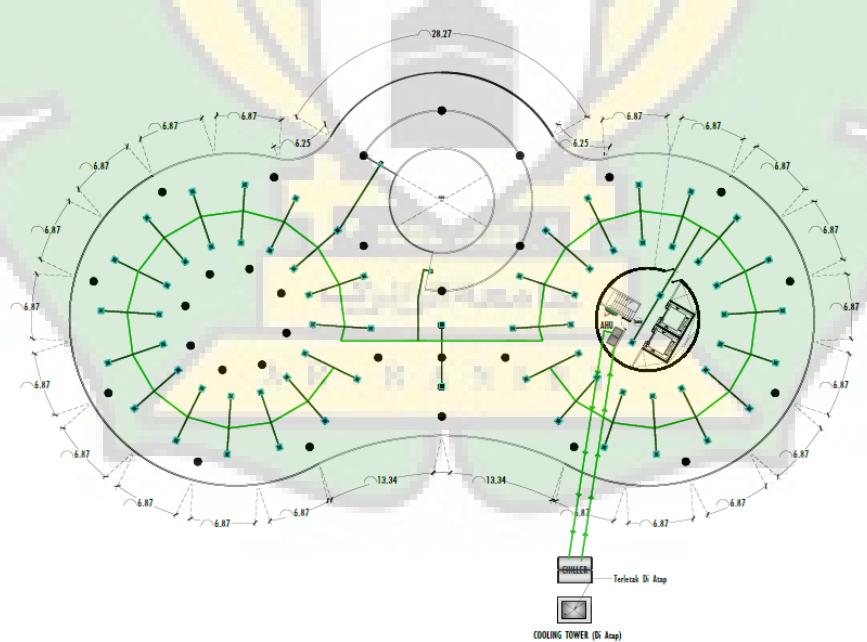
61 Denah Rencana AC Lantai 1
